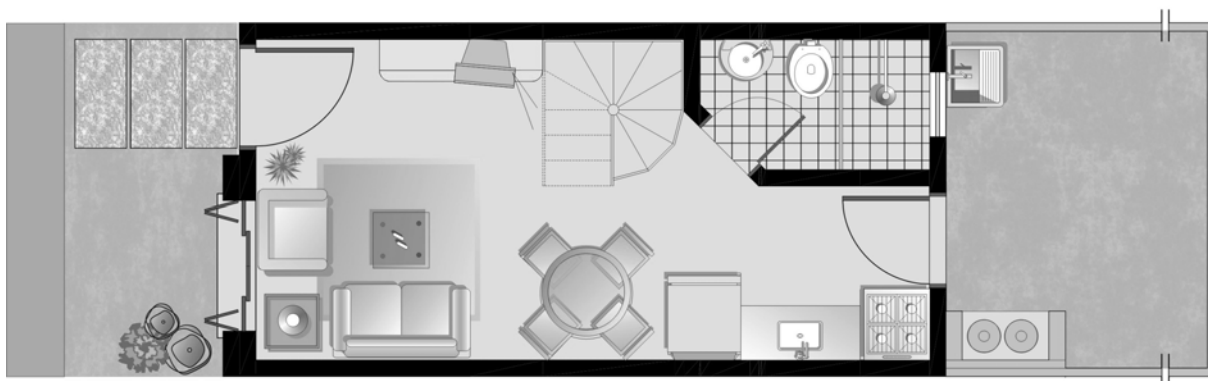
Planta do Pavimento Térreo do Sobrado - UH009
